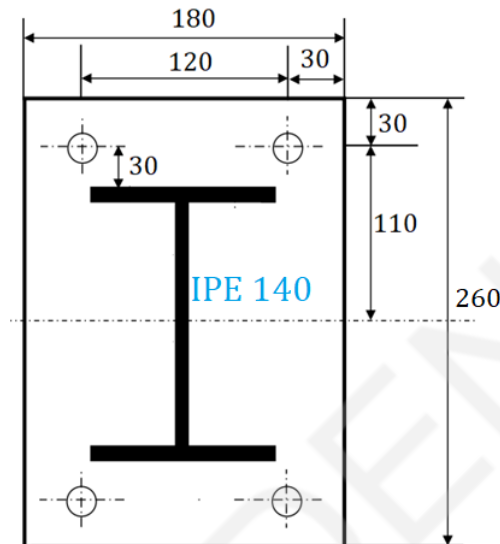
Configuration d'assemblage pied du poteau-sol
